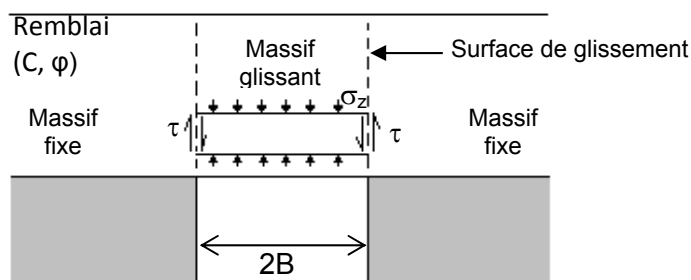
Équilibre d'un volume de sol au droit d'une cavité (coupe sur tranchée ou cavité circulaire)
